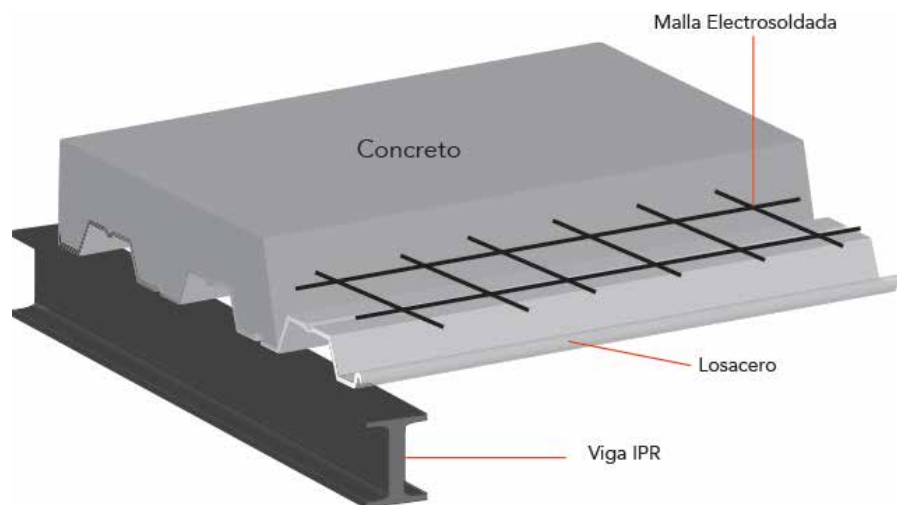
Losacero. Fuente: <http://www.galvadeck.mx/losacero.html>. Gómez (2016).
